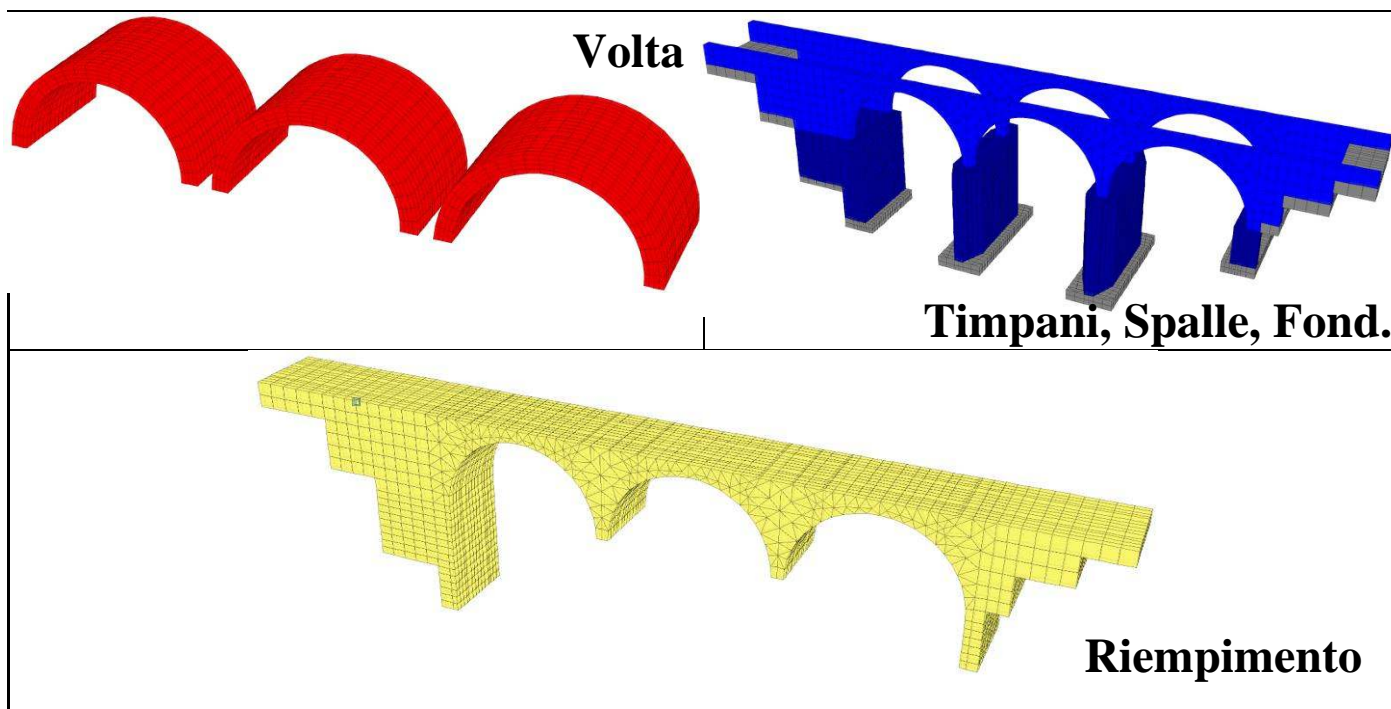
Volta; Muri di timpano, Spalle e Fondazione; Riempimento.
